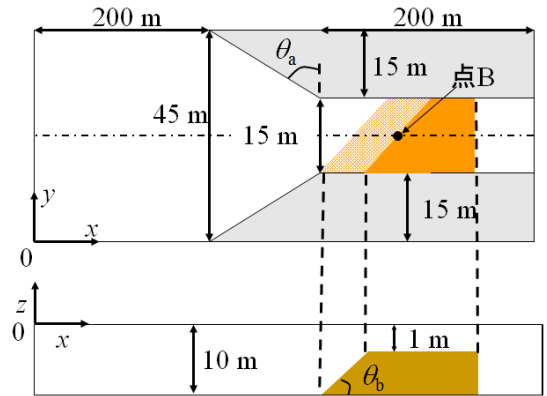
集波構造物（上図が plan view で、下図が side view を示している。）
